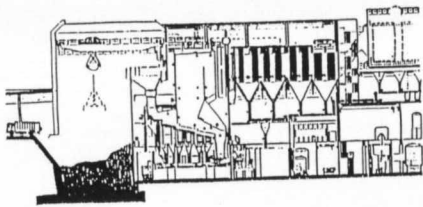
Beaufschlagung einer Müllverbrennungsanlage mit Haus- und Gewerbemüll (ohne Vorbehandlung)
